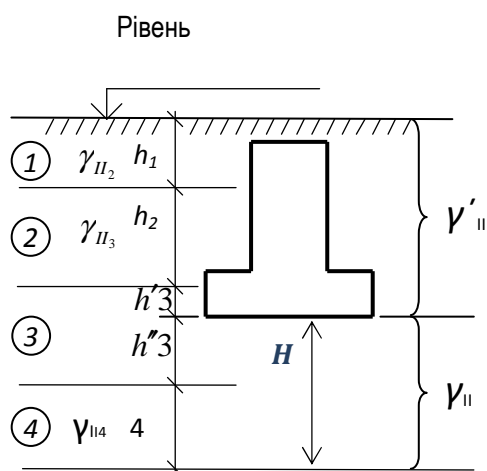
Схема до розрахунку питомої ваги ґрунтів, розташованих вище і нижче підшви фундаменту
